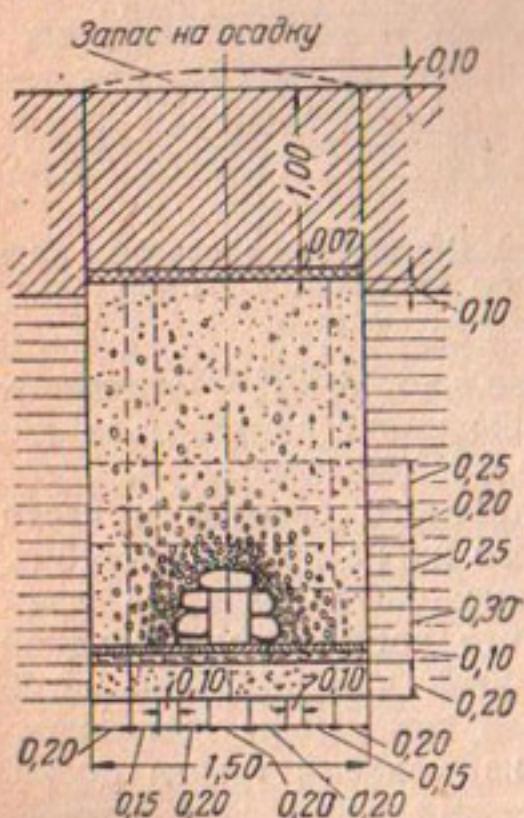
Деревянные дренажные трубы из досок на хомутах
